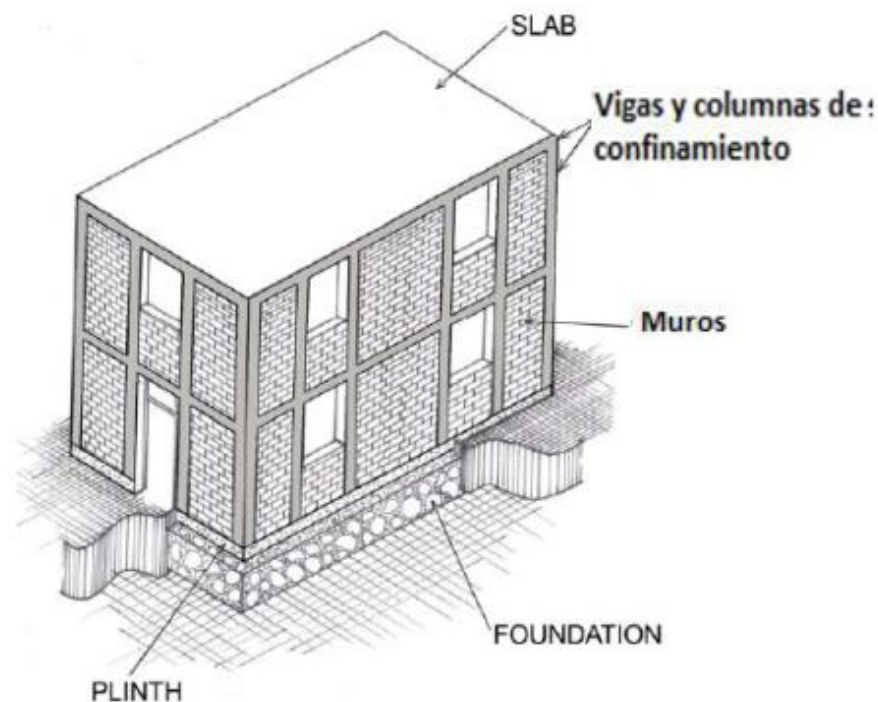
Edificio explicativo de mampostería confinada Fuente: (Brzev, 2007)
